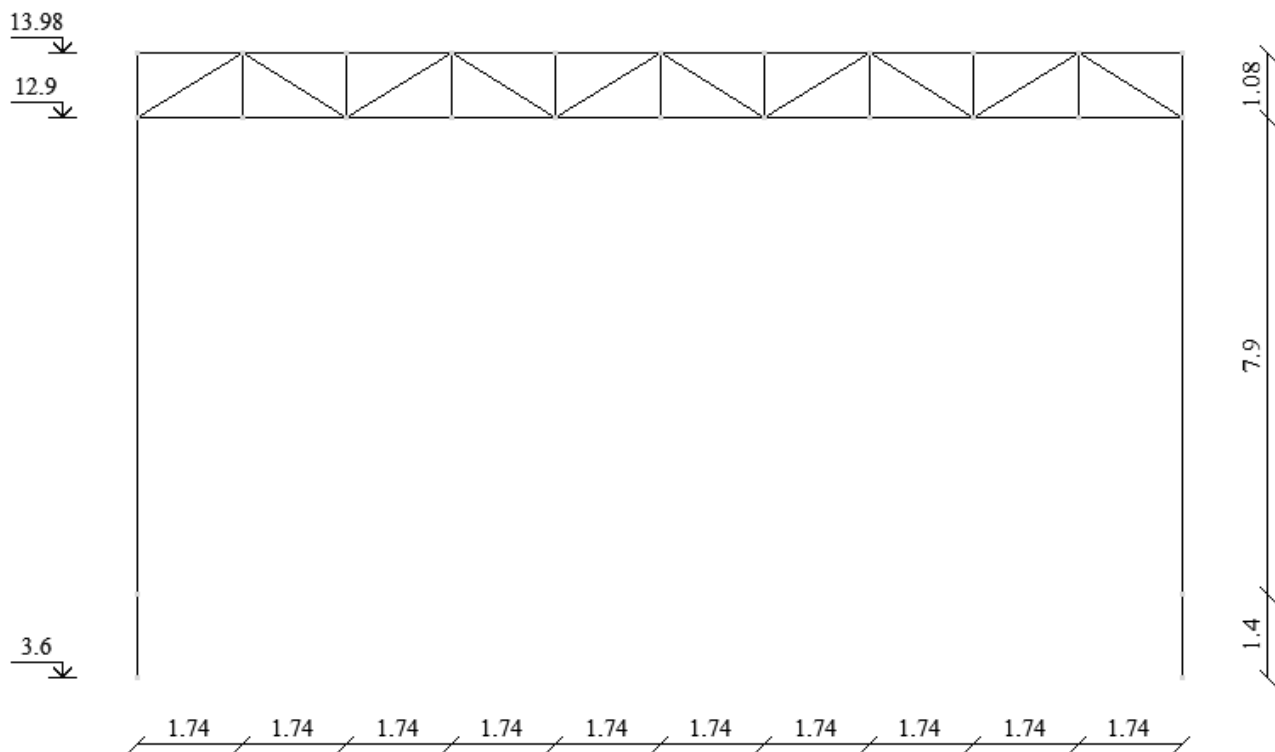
Расчетная схема поперечной рамы каркаса теннисного корта
